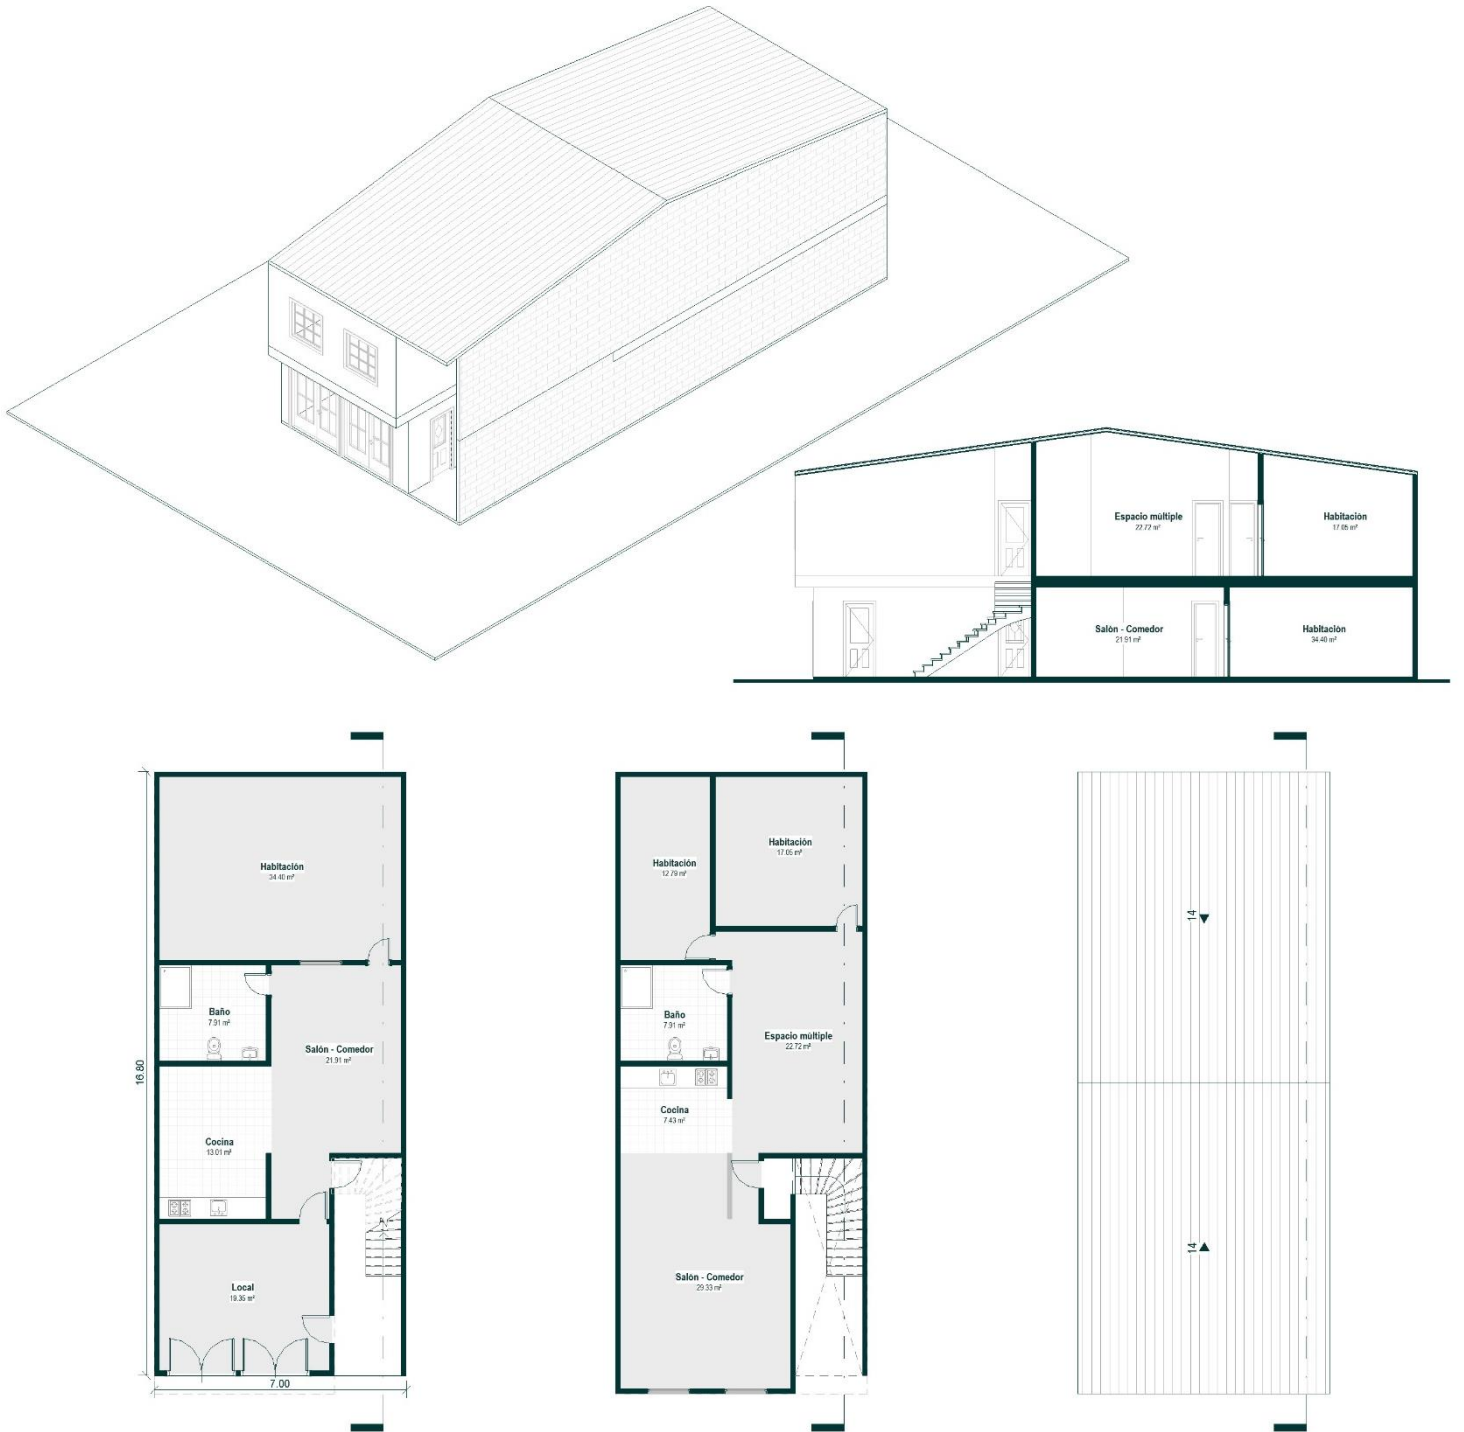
Vivienda de dos niveles sin patio y con acceso independiente y retranqueado para planta baja y planta primera, lo que sugiere un uso plurifamiliar que adquiere una connotación de doble productividad en planta baja. *Elaboración propia a partir de* (Tarchópulosa Sierra & Ceballos Ramos, 2003; Torres Tovar, 2009).
